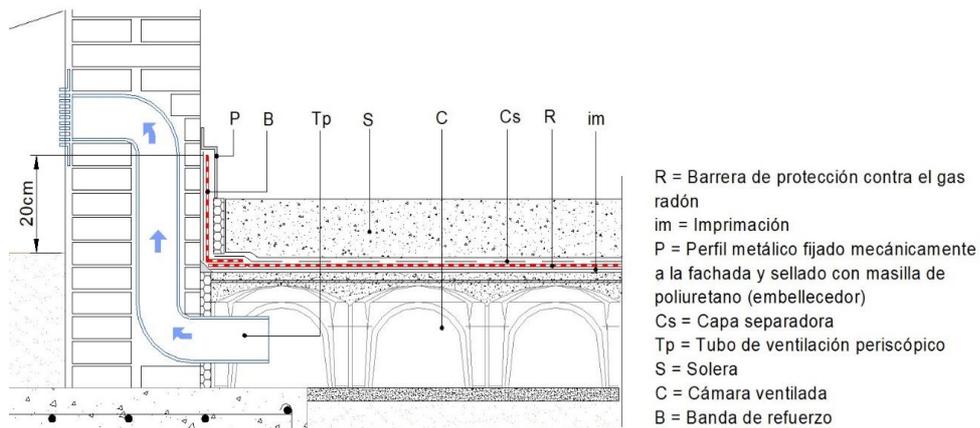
Suelo elevado: forjado sanitario ventilado y barrera de protección contra el radón. Sistema monocapa adherido.
